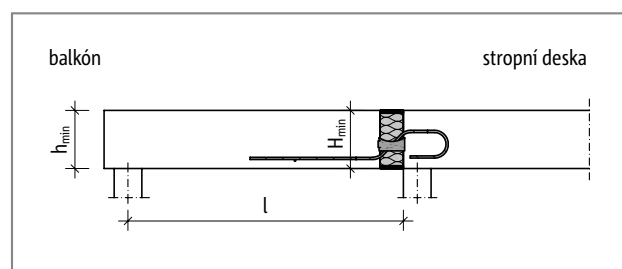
Schöck Isokorb® T typ QL-VV4 až QL-VV6: Statický systém
